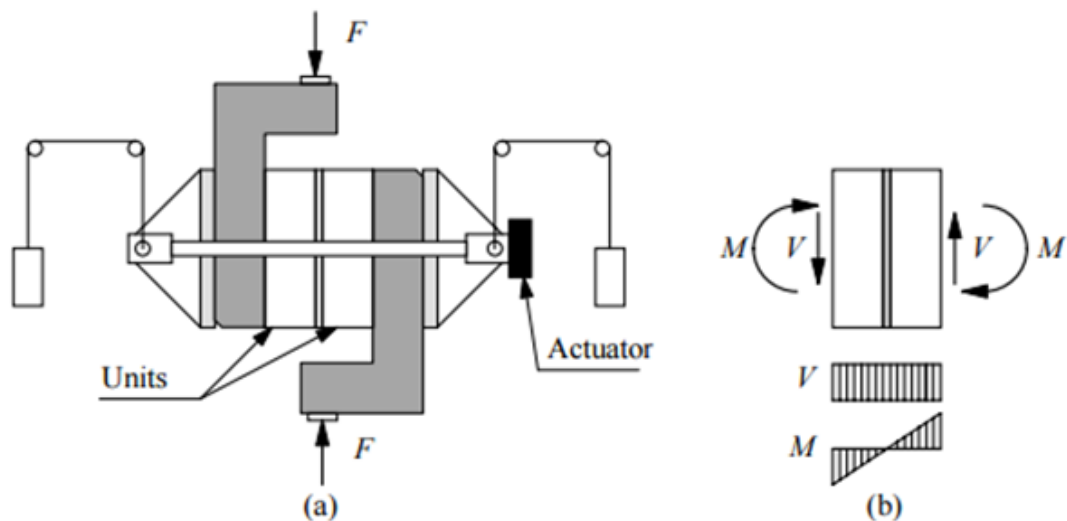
Prueba para obtener el comportamiento a cortante: a) espécimen listo para ser ensayado; b) fuerzas aplicadas durante el ensayo. Adaptado de (Lourenco, 1998)
